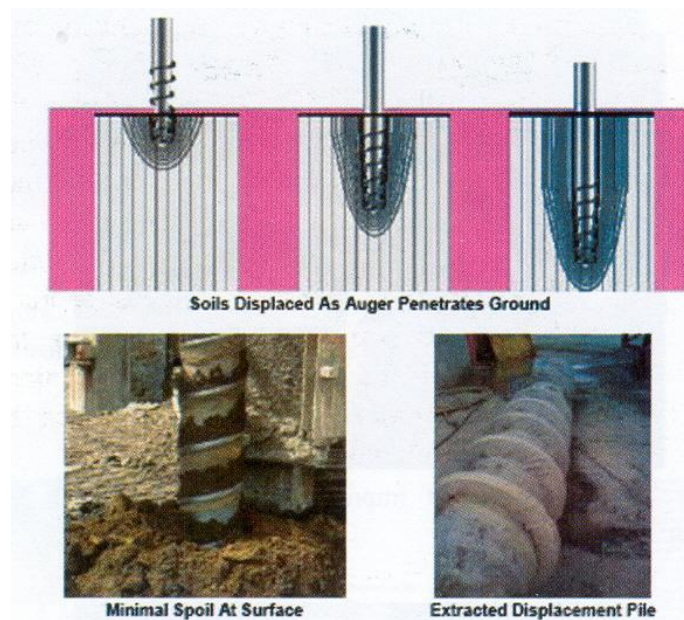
Secuencia de construcción con pilas de desplazamiento.
